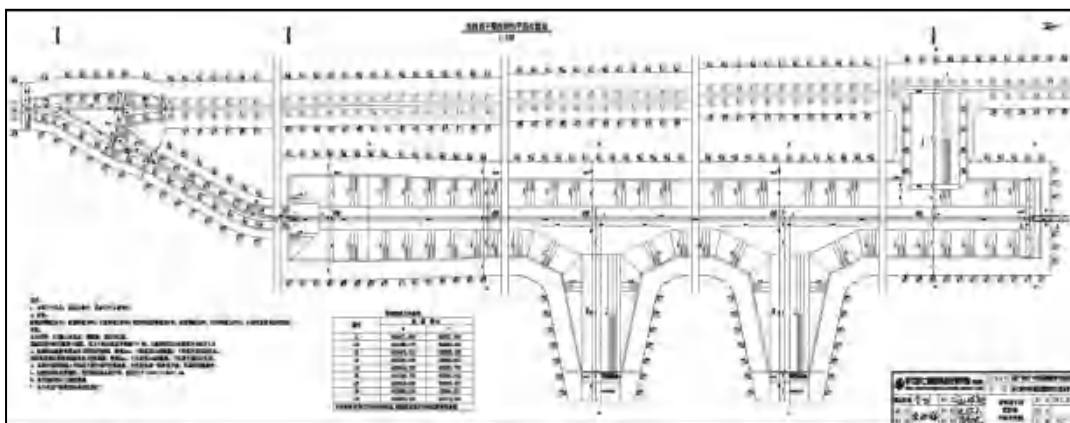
老双河干渠、双河西干渠沉砂池平面布置示意图（单池）
